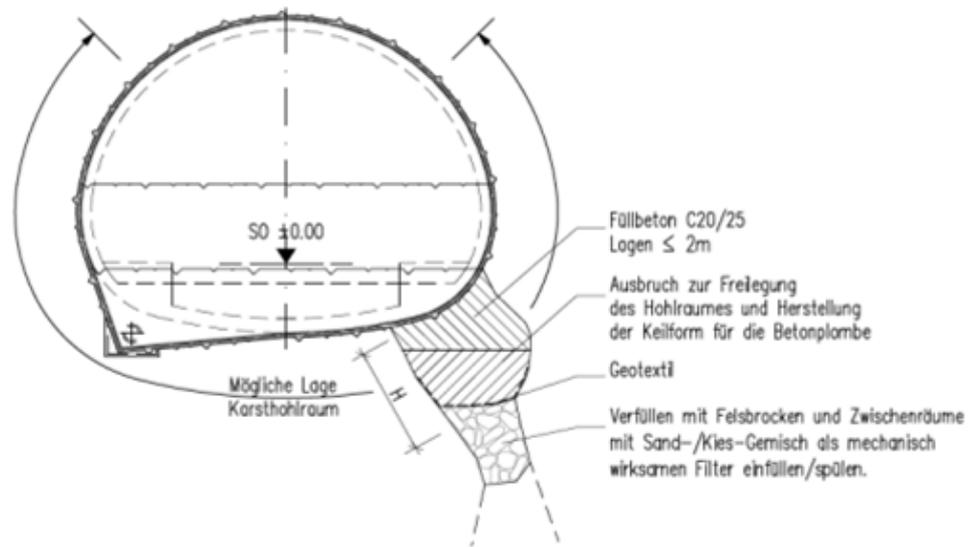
Beispiel einer Hohlraumsanierung im Tunnel Imberg
